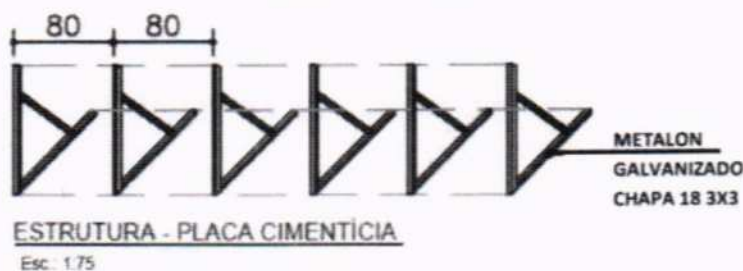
Detalhamento da estrutura. Metalon 3x3 chapa 18.
